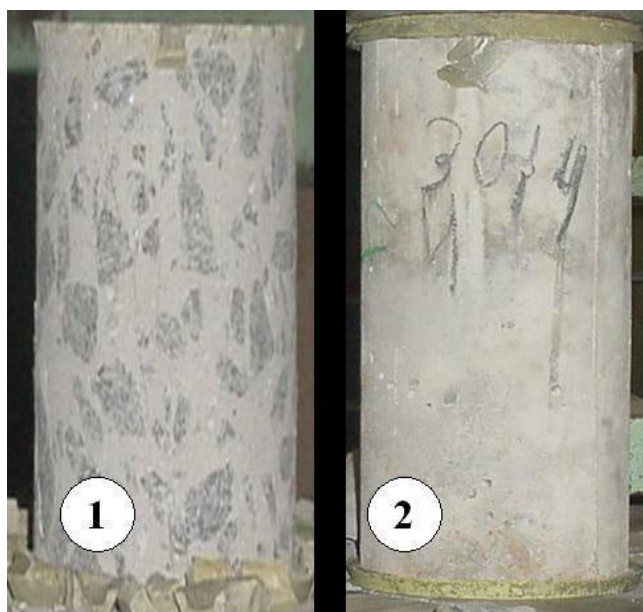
Diferença entre a superfície do testemunho (1) e a superfície do corpo-de-prova padronizado (2).
